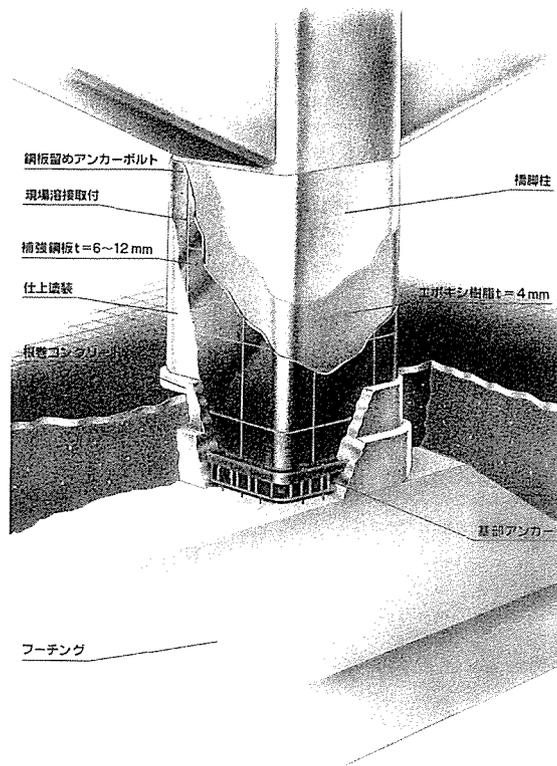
コンクリート橋脚鋼板巻立耐震補強概要図
